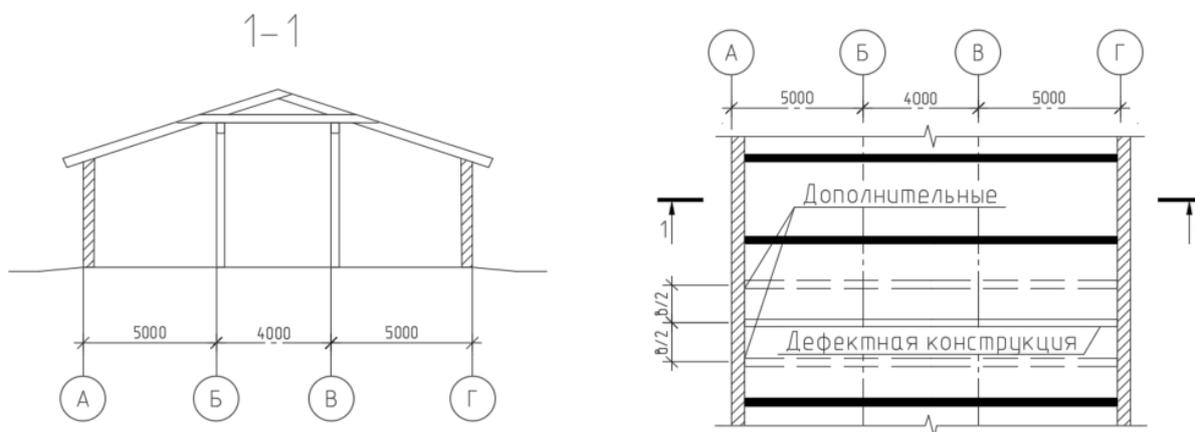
Усиление за счет дополнительной установки самостоятельно работающих стропильных ног, разгружающих дефектную конструкцию
